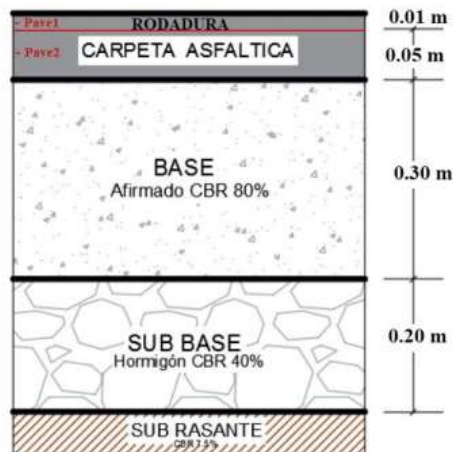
Estructura de pavimento flexibles y medidas (MTC, 2018)
